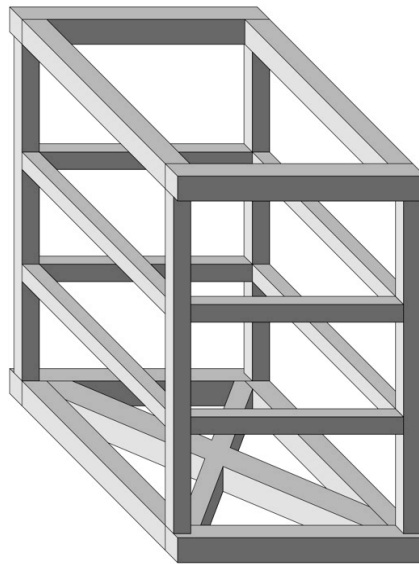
Perspetiva do módulo de perfis de aço utilizado na construção das vigas
